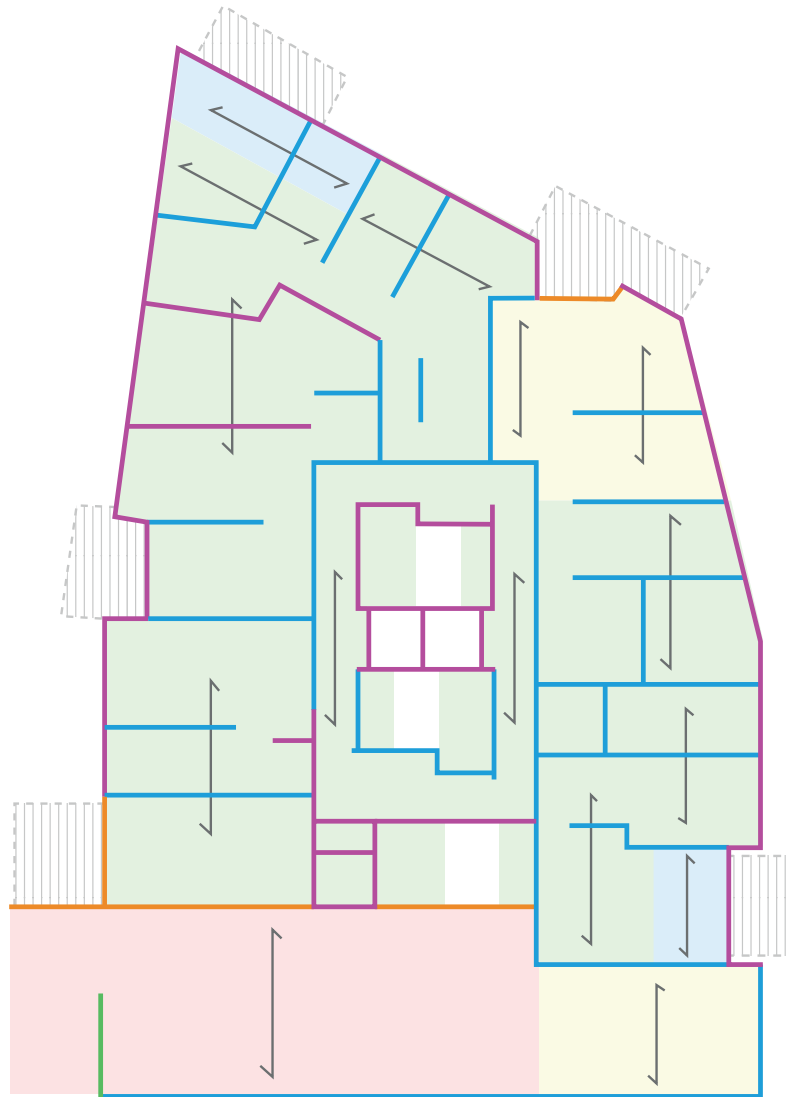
Planta tipo del bloque este. Escala 1:200
